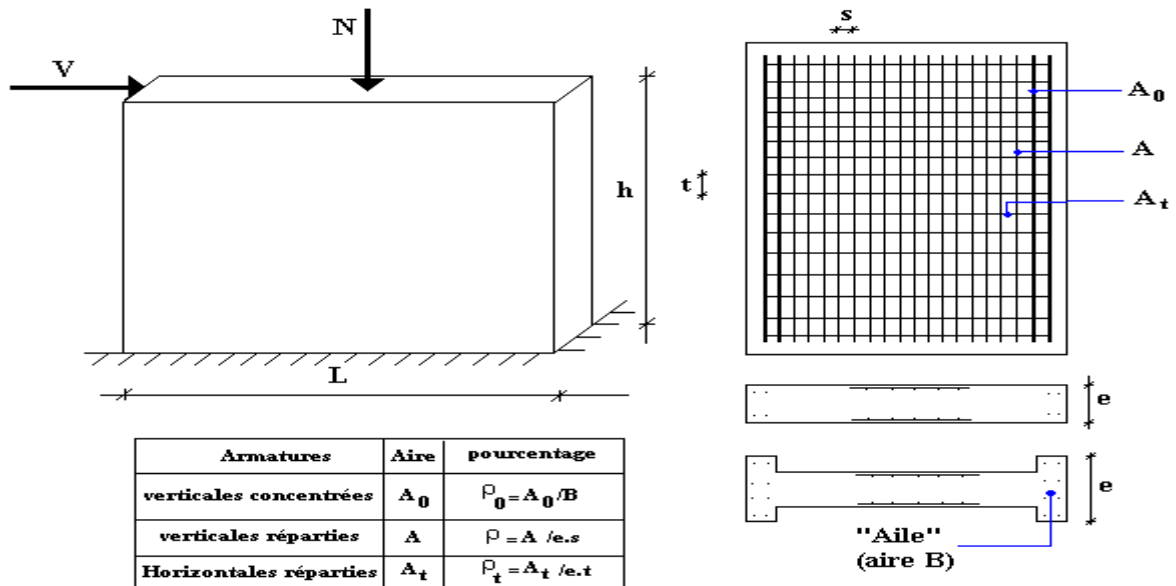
Schéma d'un voile plein et disposition du ferrailage.
